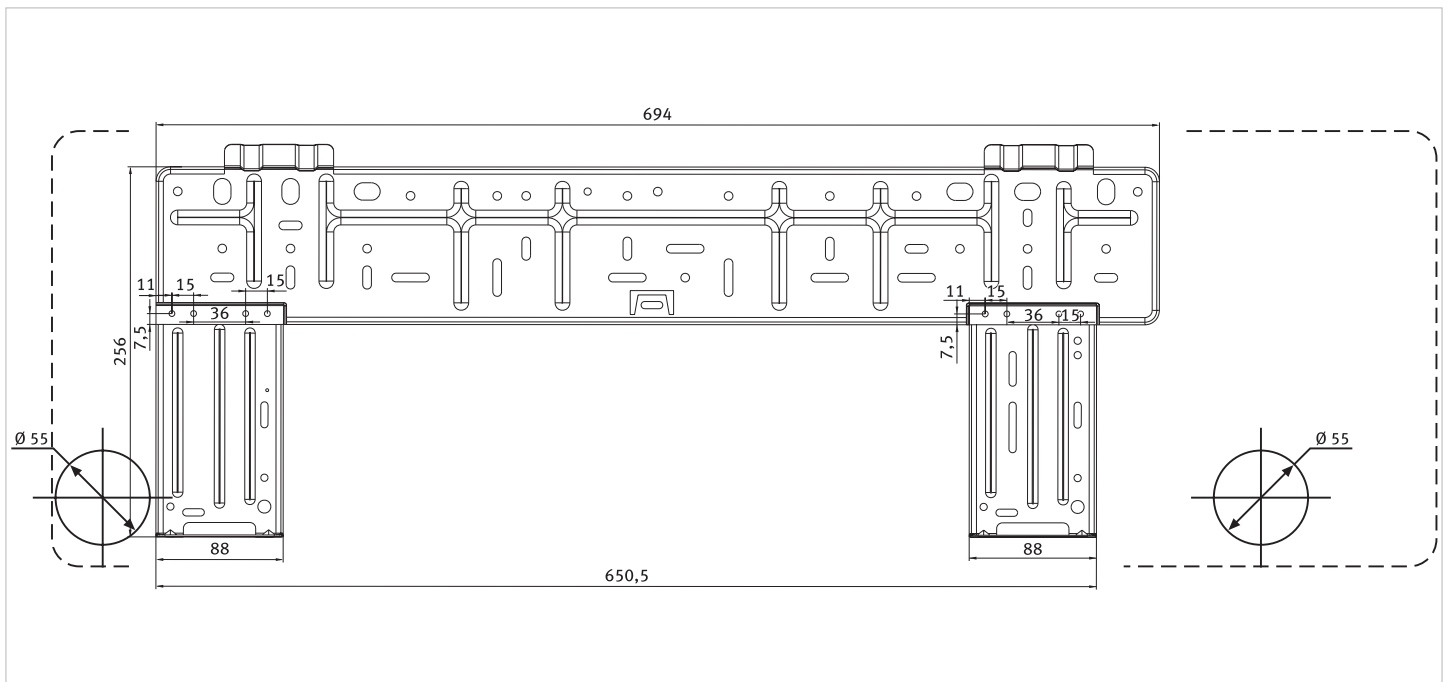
Plaque de montage du modèle 18-050 NWI
